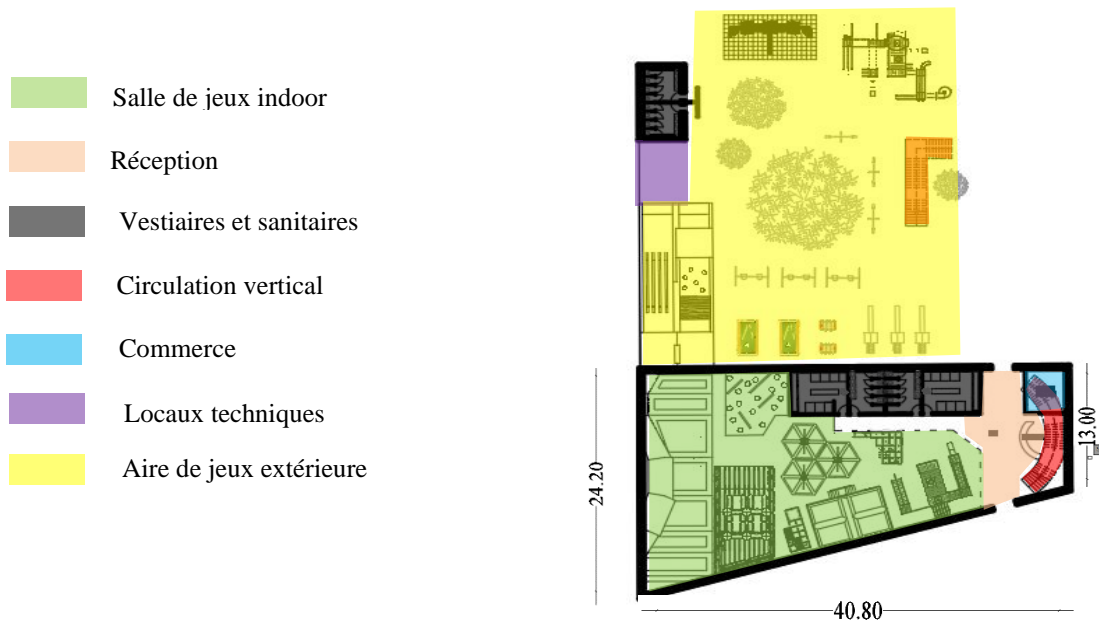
Plan RDC Ludique. (Source : Auteur)
